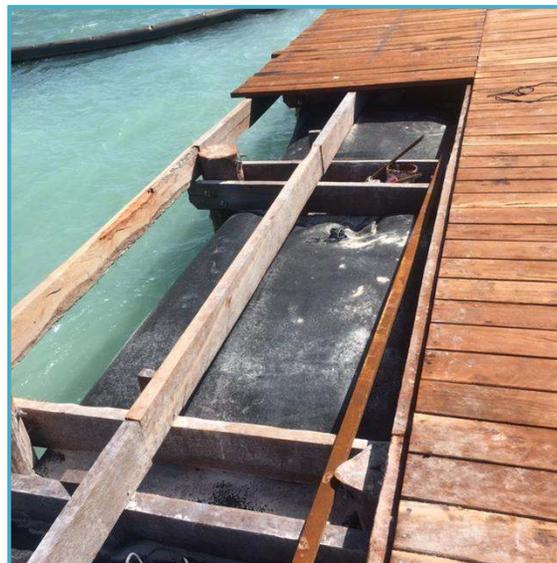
Ejemplo de sección de muelle reforzada con tubos de geotextil rellenos con arena para otro proyecto autorizado.
